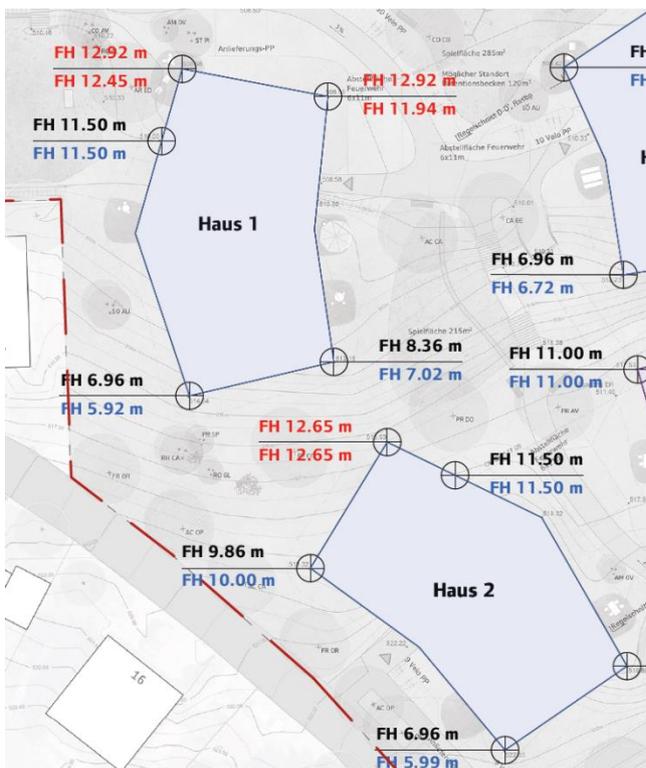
Ausschnitt Schema «Fassadenhöhen traufseitig»
